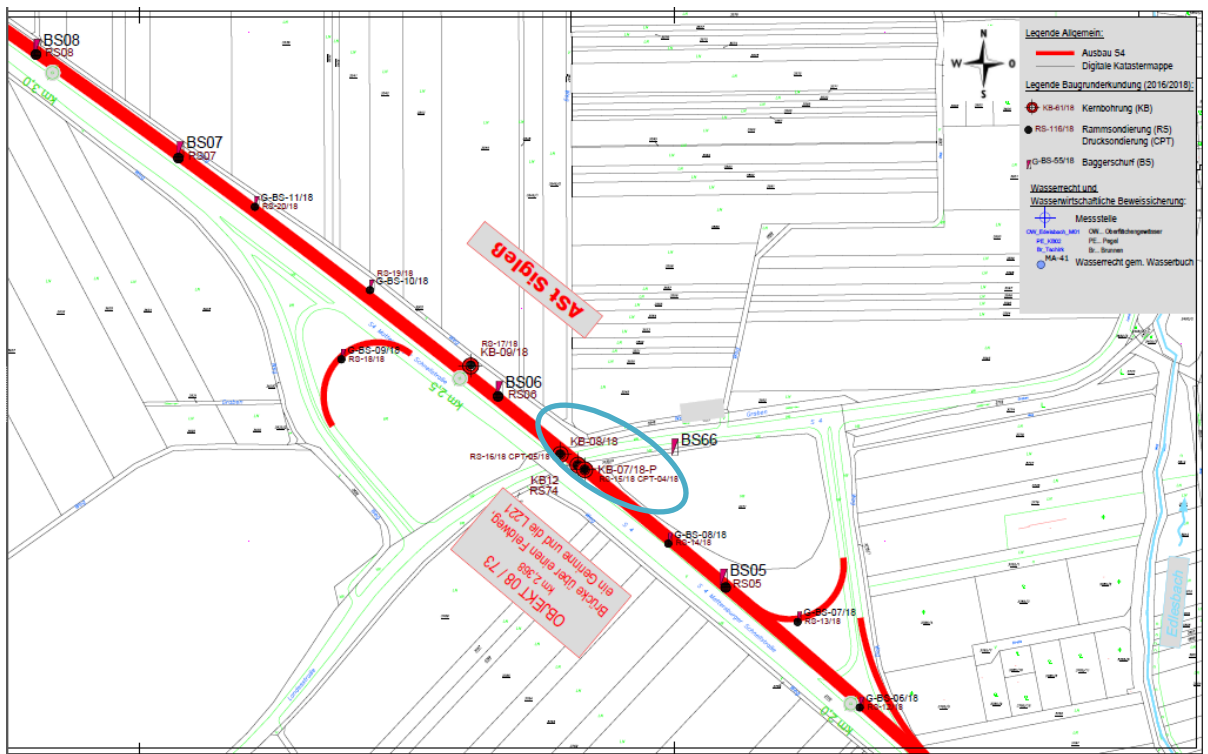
Kernbohrung 8 – Lageplan.
